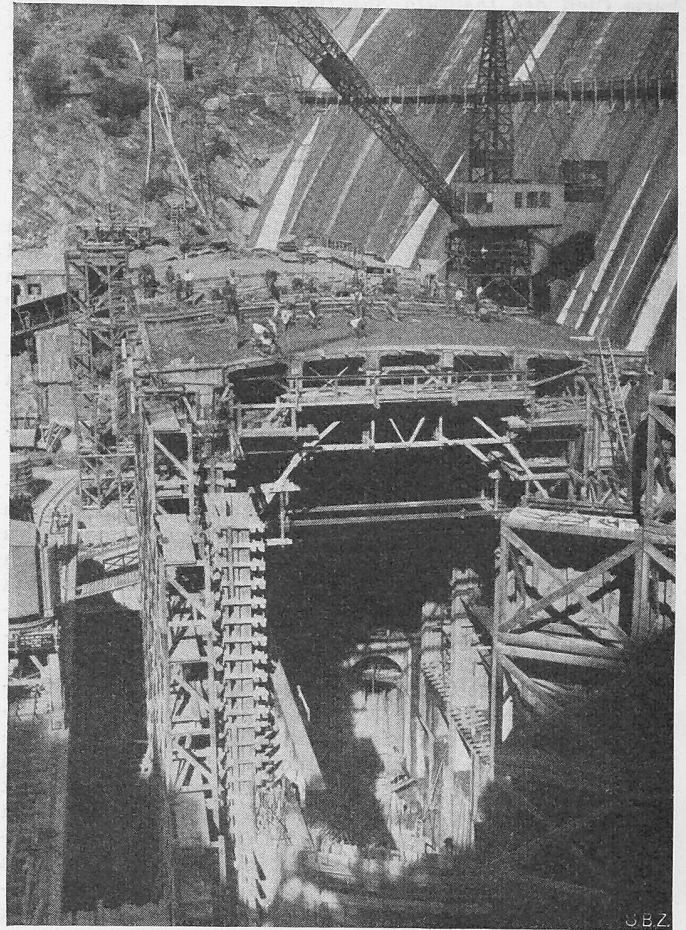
Betonierung des Maschinenhauses; fahrbare Dachschalung. 3. November 1949
